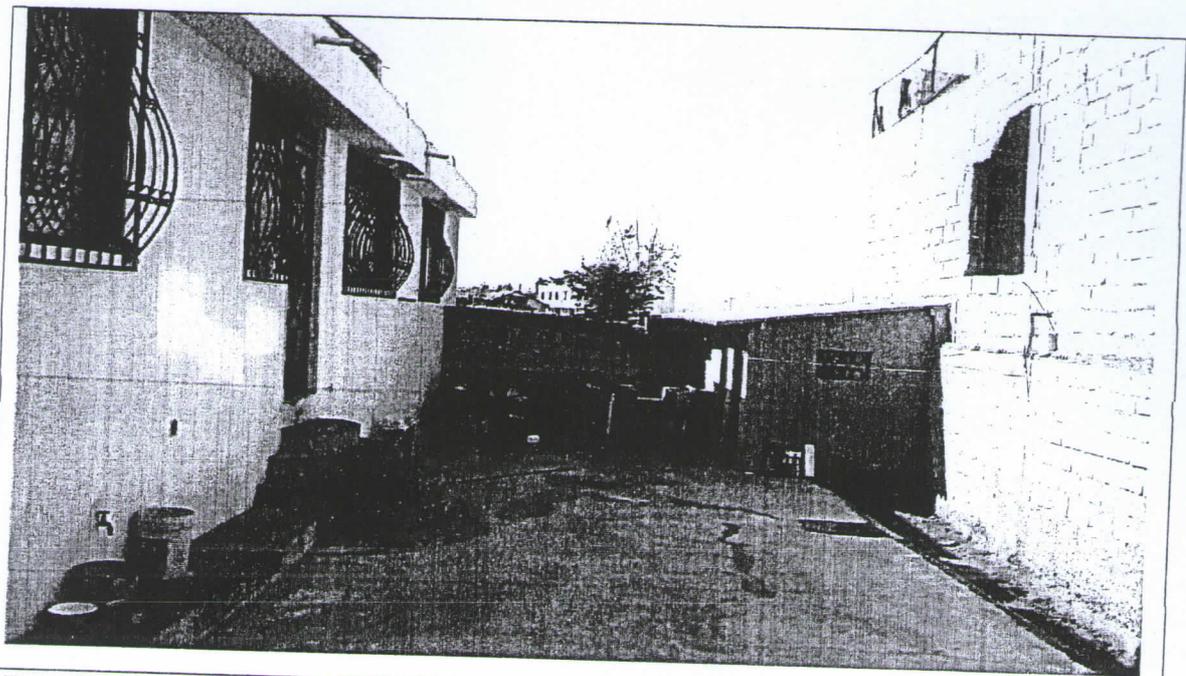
Vista interior del Lindero Sur del inmueble. Al fondo a la derecha se aprecia la construcción de una bodega.
